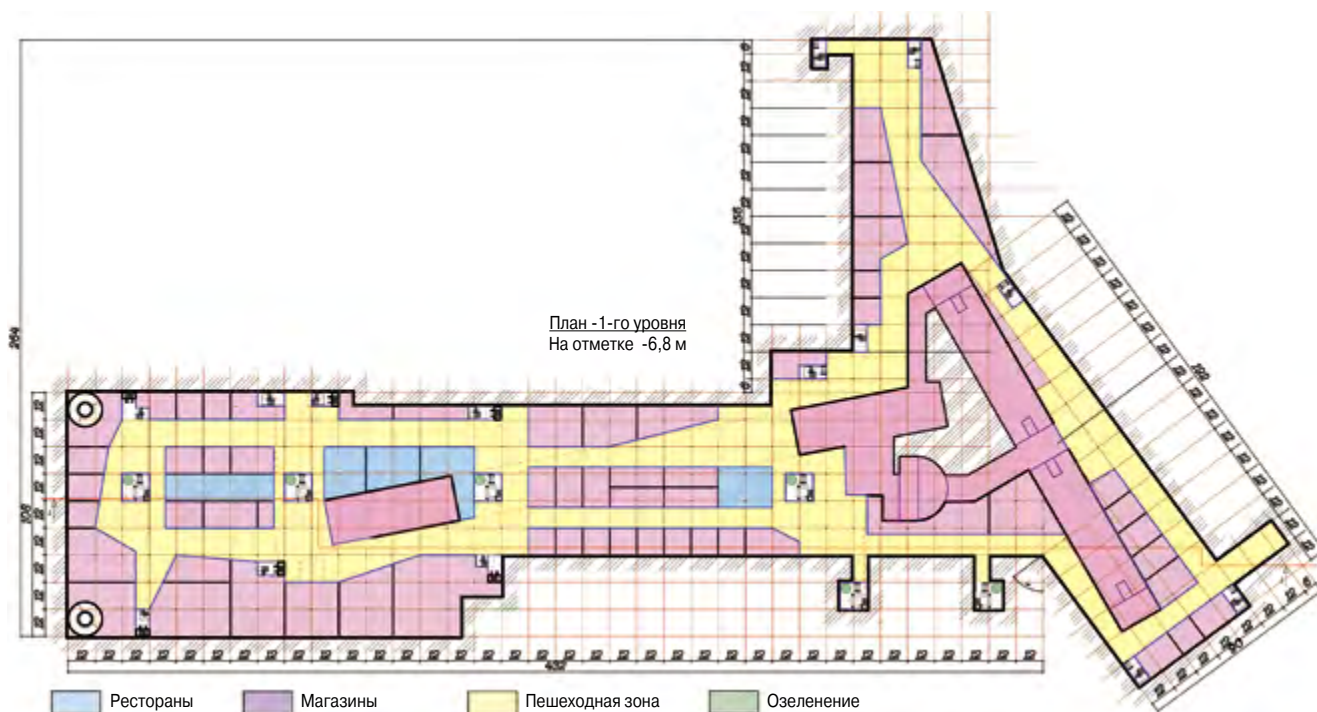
Подземное пространство под Сокольнической площадью. План -1-го этажа
